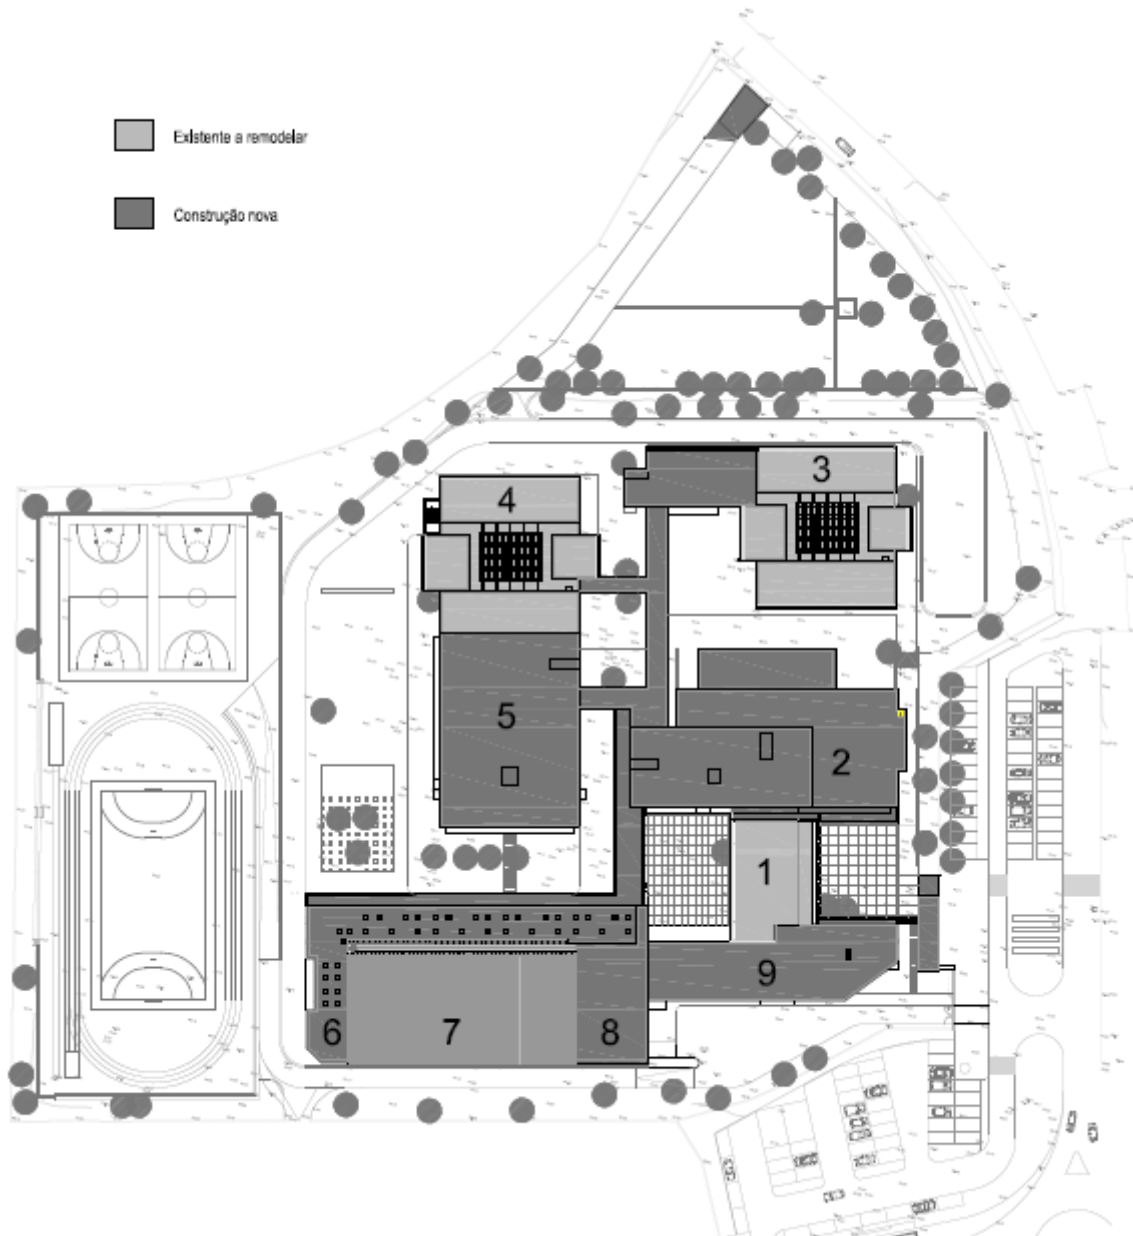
Planta com a construção nova e a existente a remodelar.
